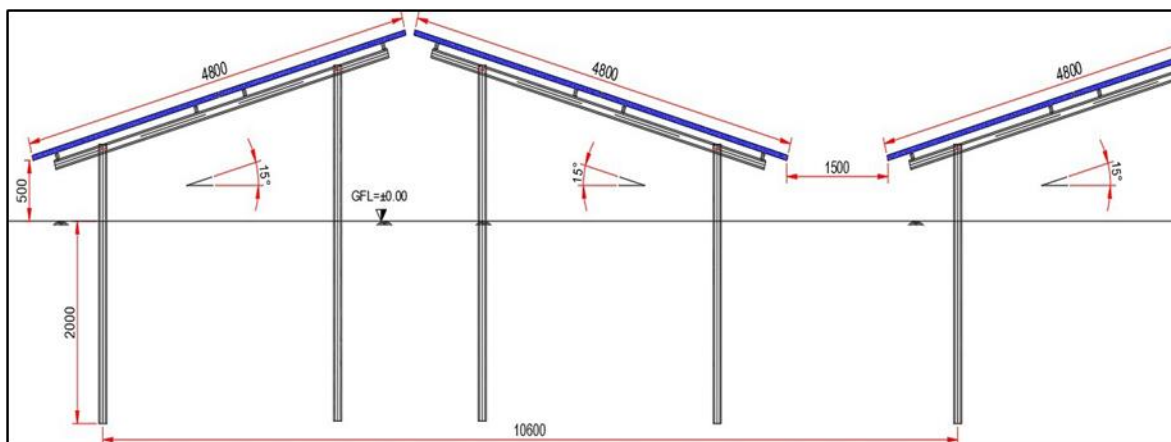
Planul și elevația în secțiune a structurii de montare a modulelor
